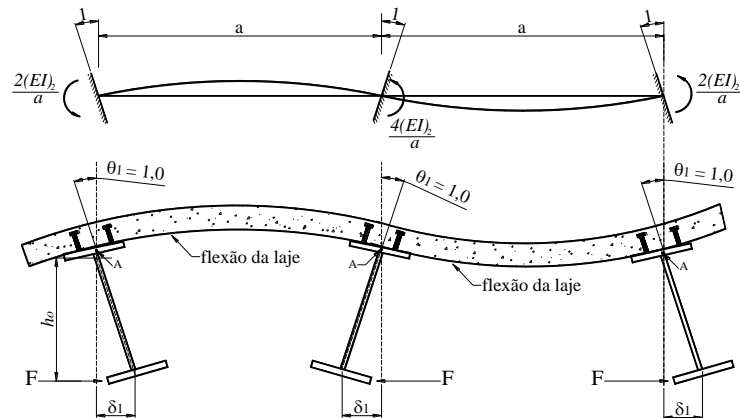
Rigidez Rotacional da laje fissurada
